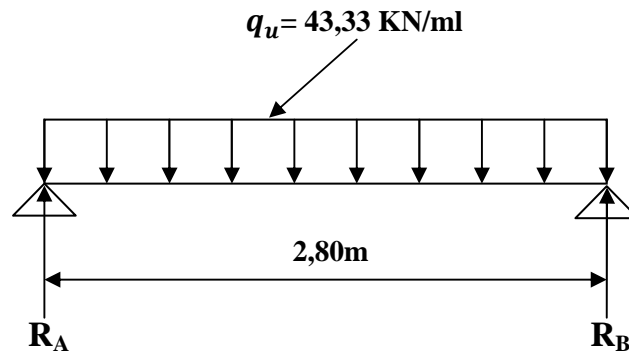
Schéma statique de la poutre palière à l'ELU.
